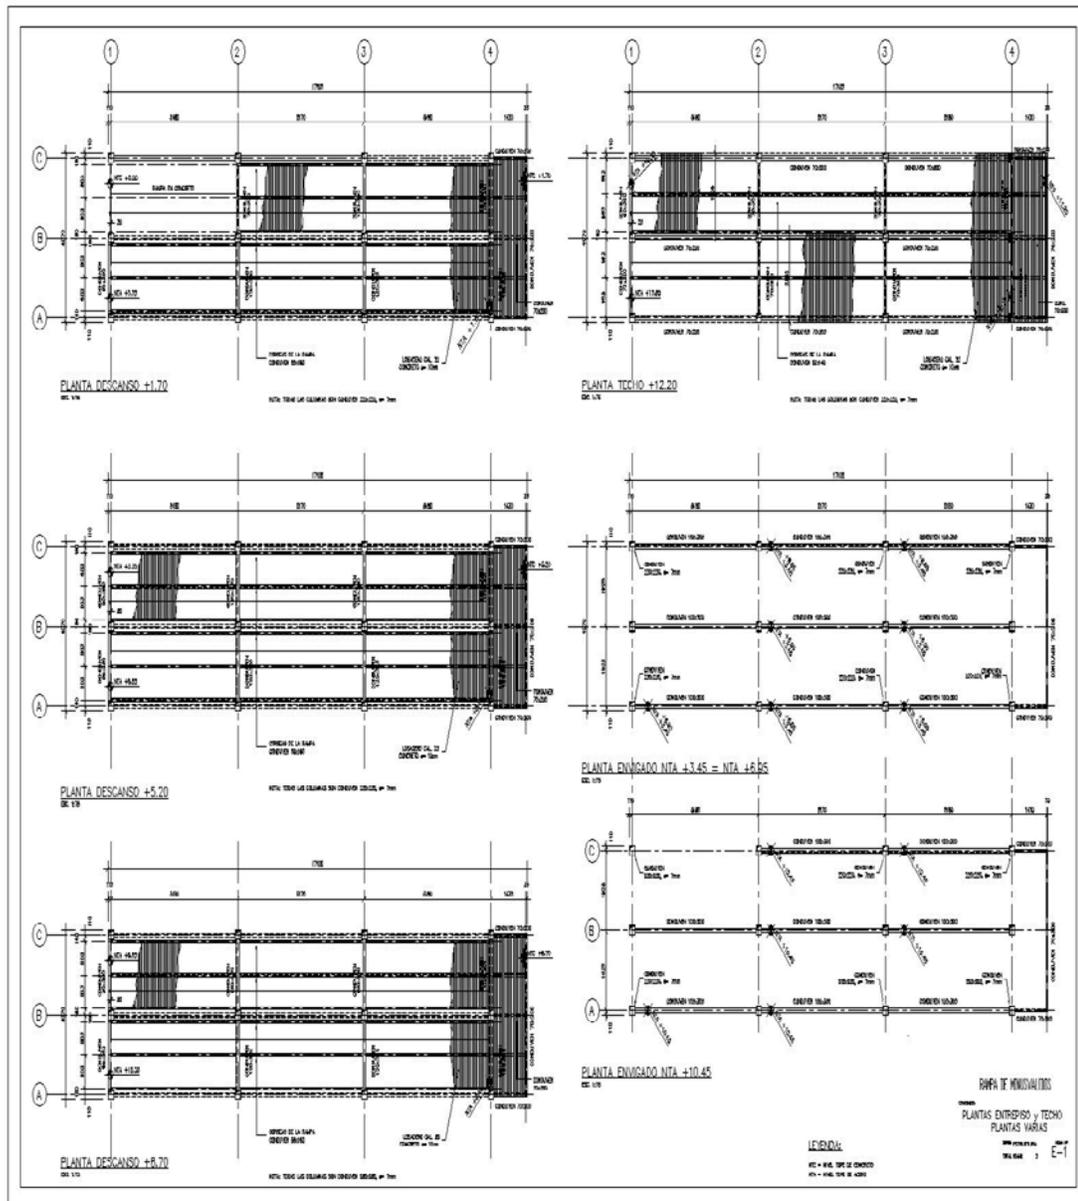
Planos de Rampa de Acceso Externa, Vigas, Columnas, Aceros
